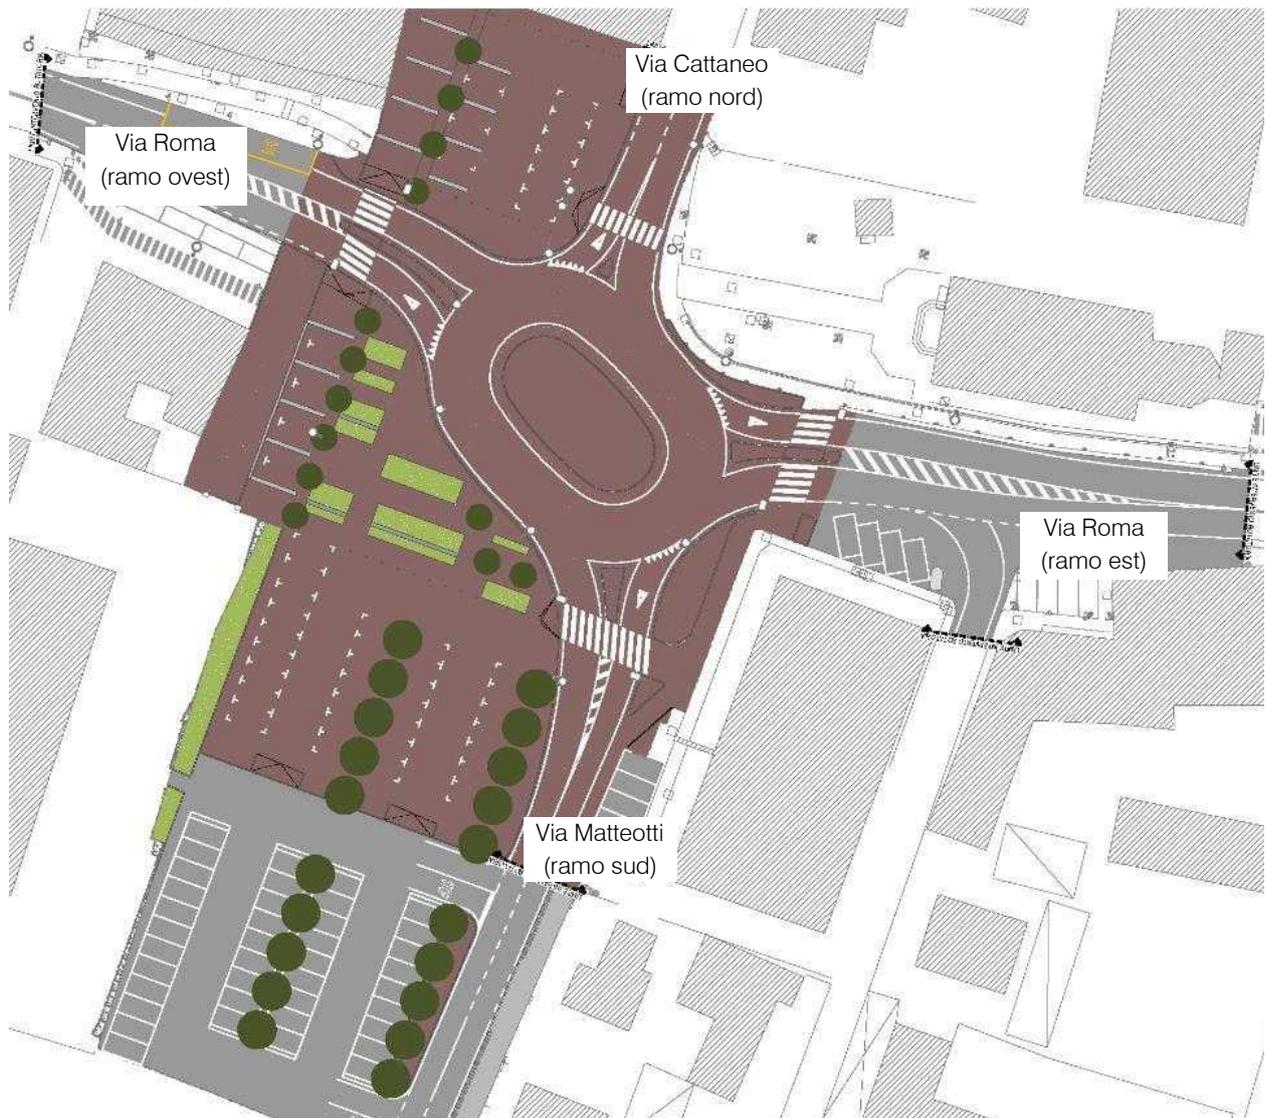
Planimetria di progetto – Scenario lungo periodo (non oggetto di richiesta di autorizzazione paesaggistica)
